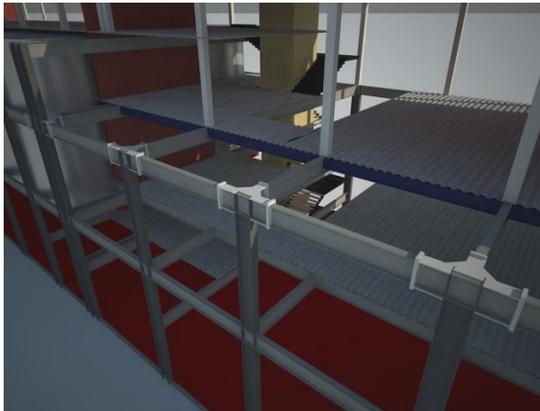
Imágenes Detalles Estructura Centro Cultural
